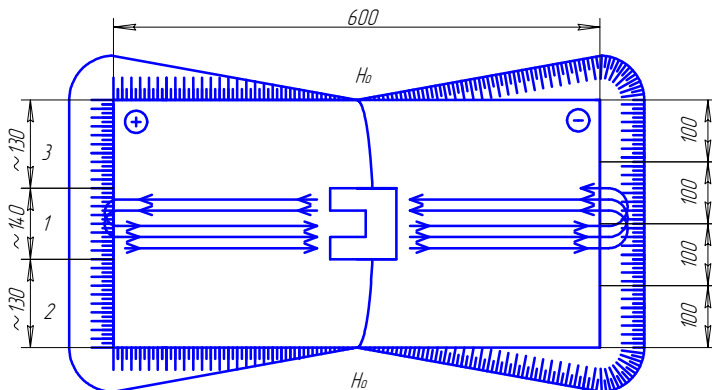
Примерная схема продольной планировки площадки с разбивкой на три равных участка
